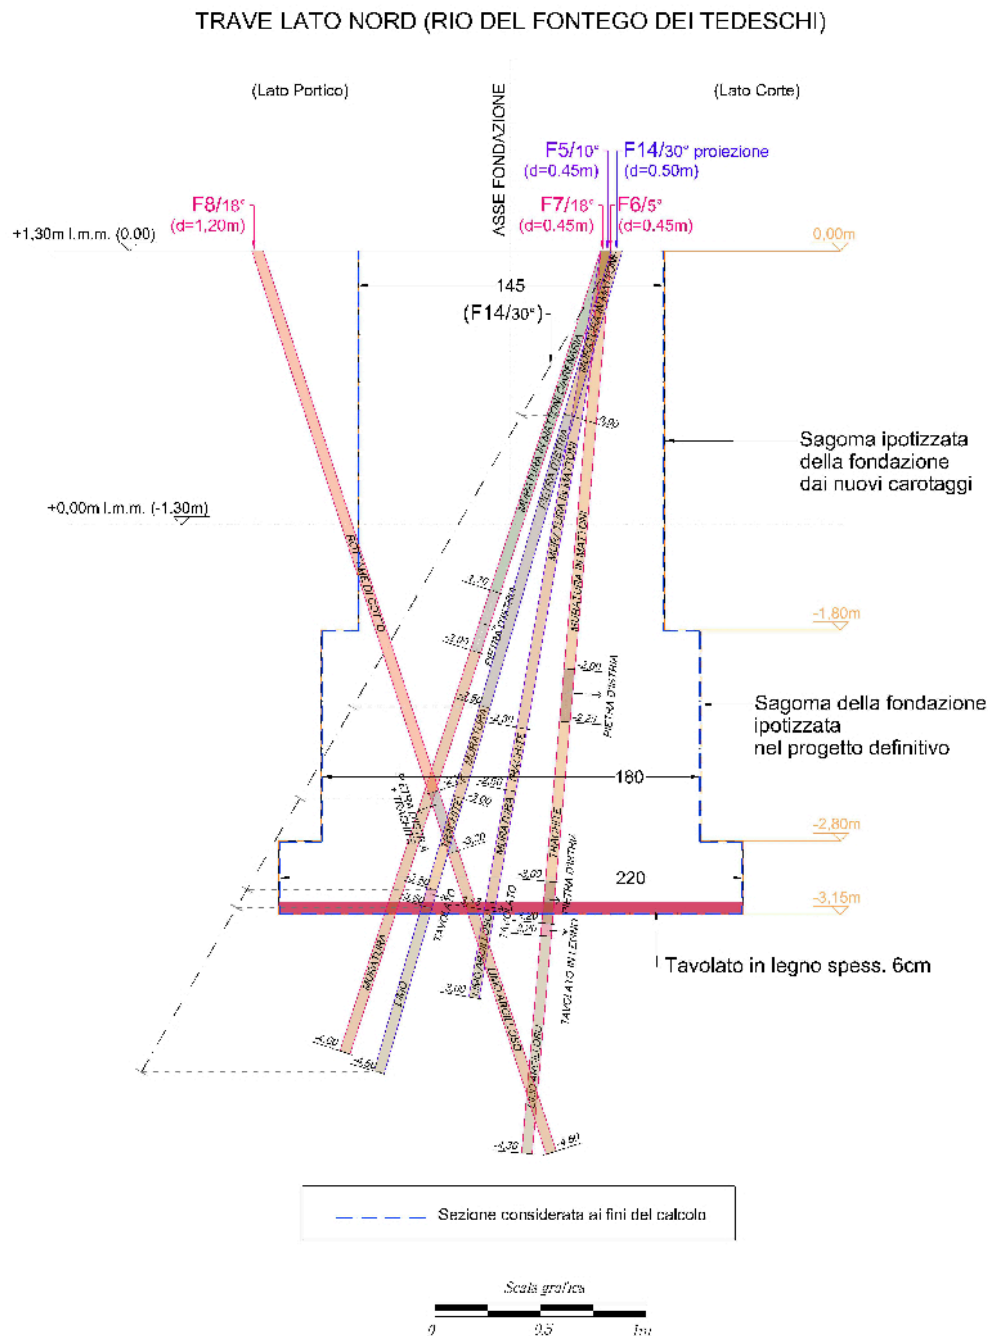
Restituzione della sezione delle fondazioni esistenti lato Nord
